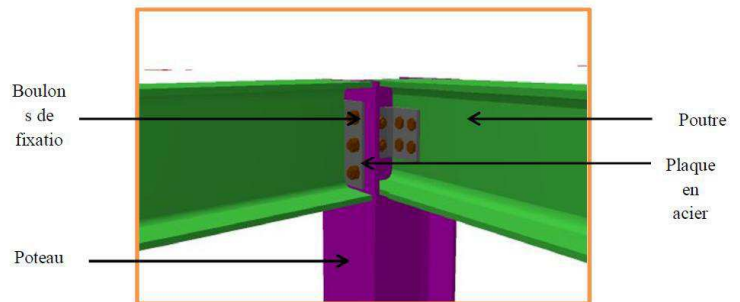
Schéma représentatif de l'assemblage poteau -poutre
